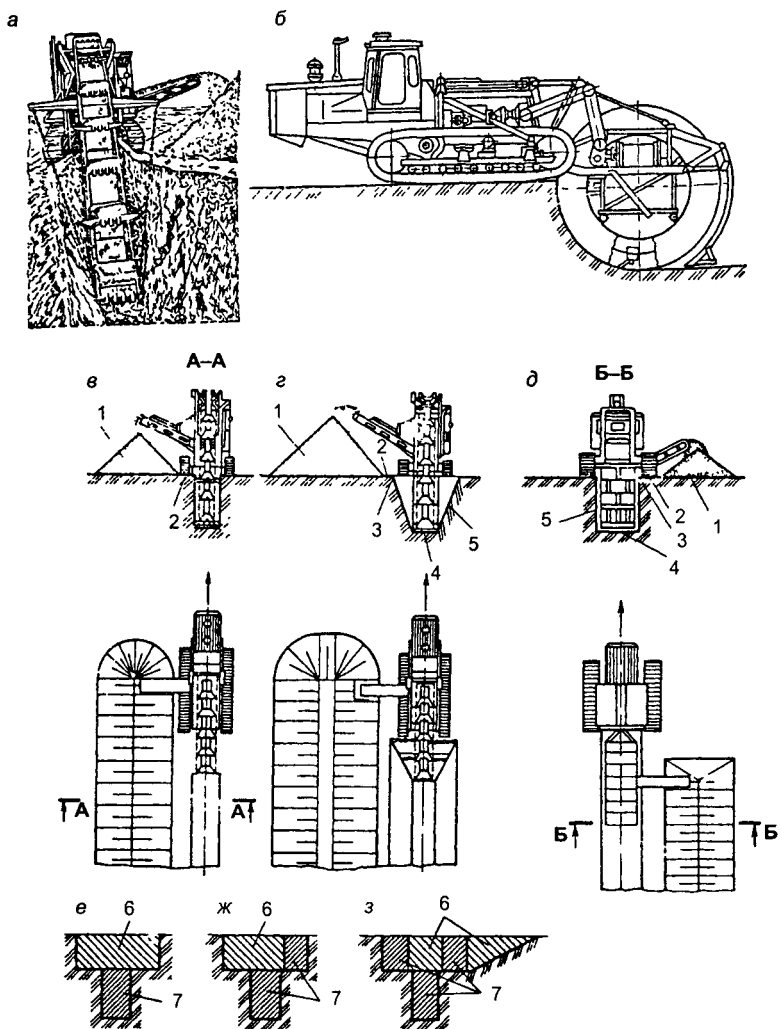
Схемы разработки грунта при отрывке траншей многоковшовыми экскаваторами:
